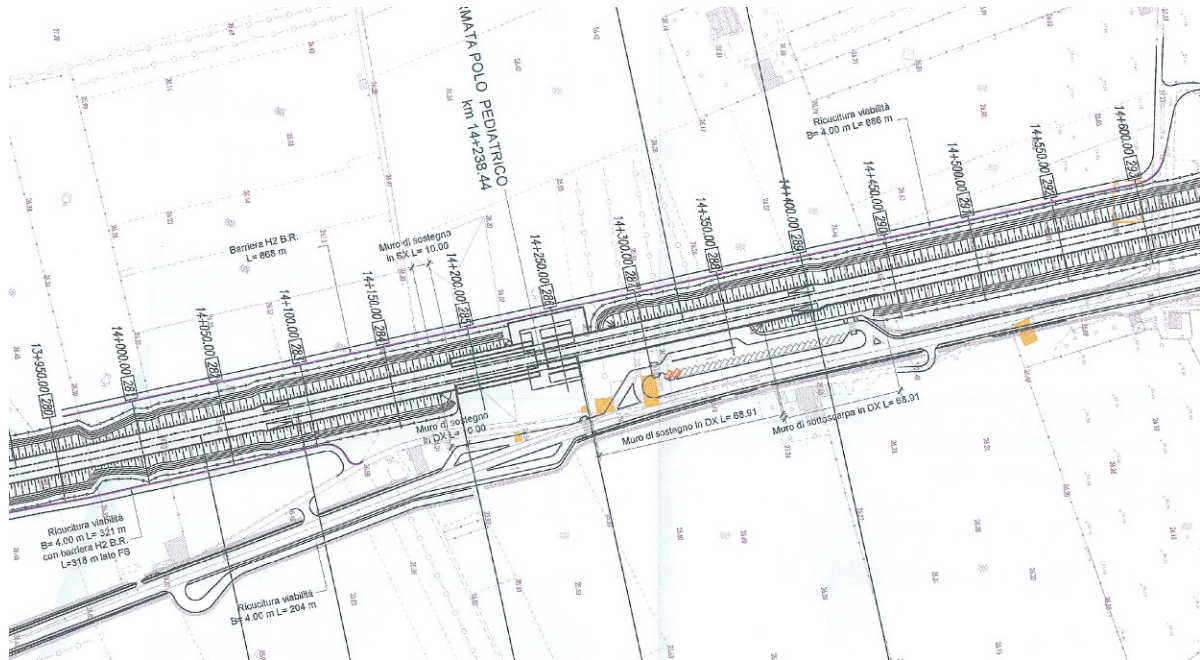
Contesto di analisi F – Progetto Definitivo - Planimetria
